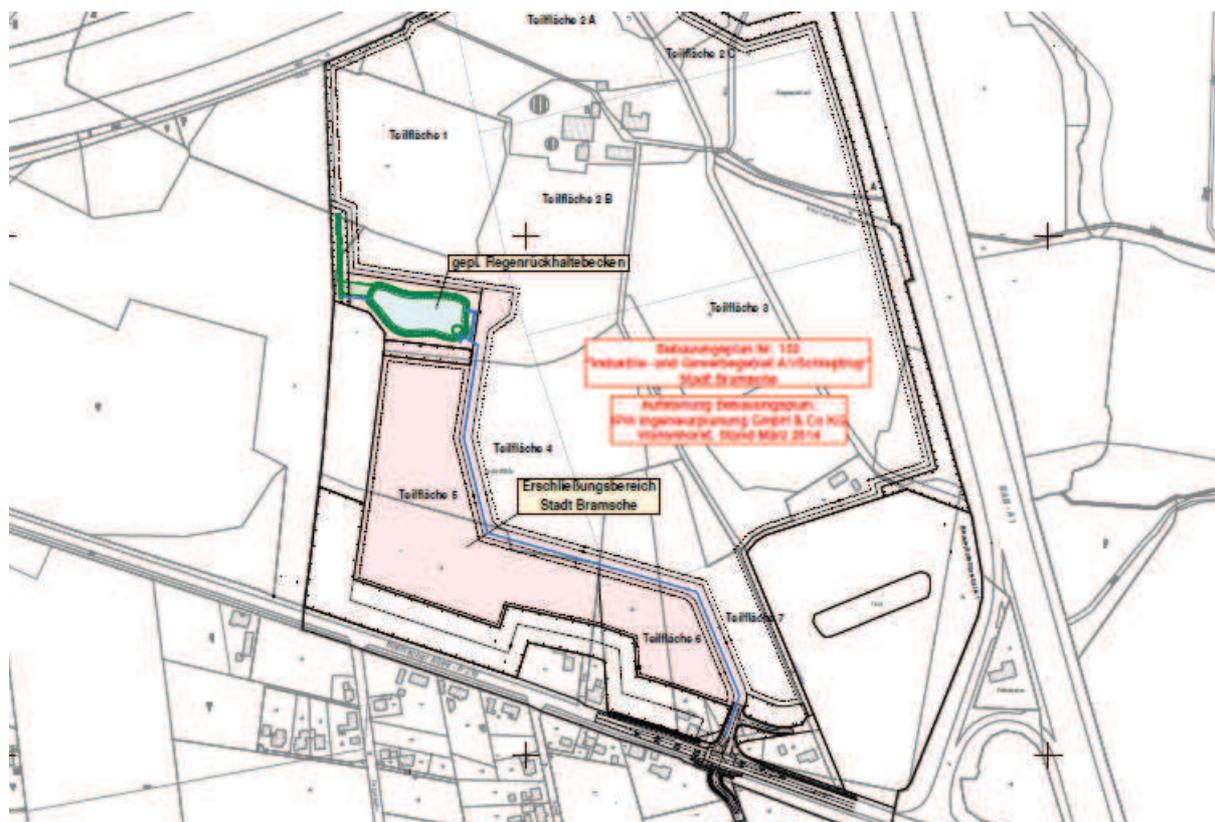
Übersichtslageplan Entwässerungskonzept (Büro Westerhaus)
